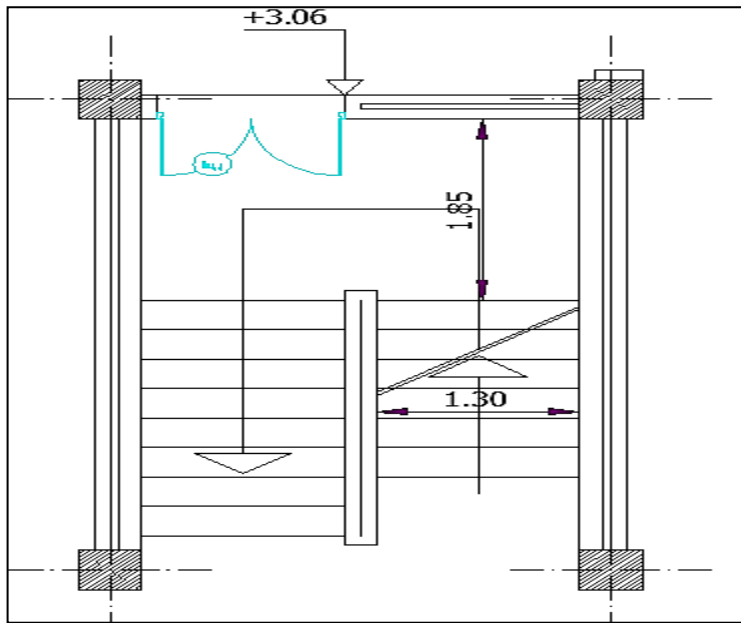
Vue en plan de l'escalier a deux volées.
